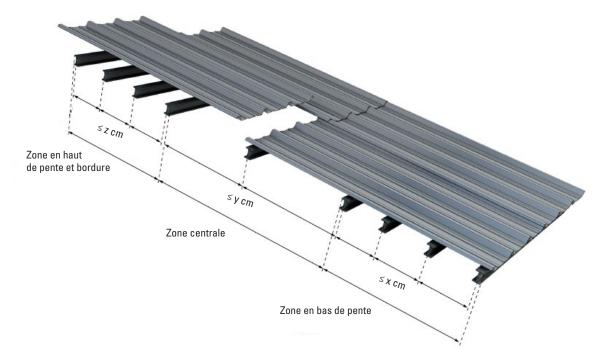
Pannes bois ou métalliques fixées directement sur la structure porteuse
